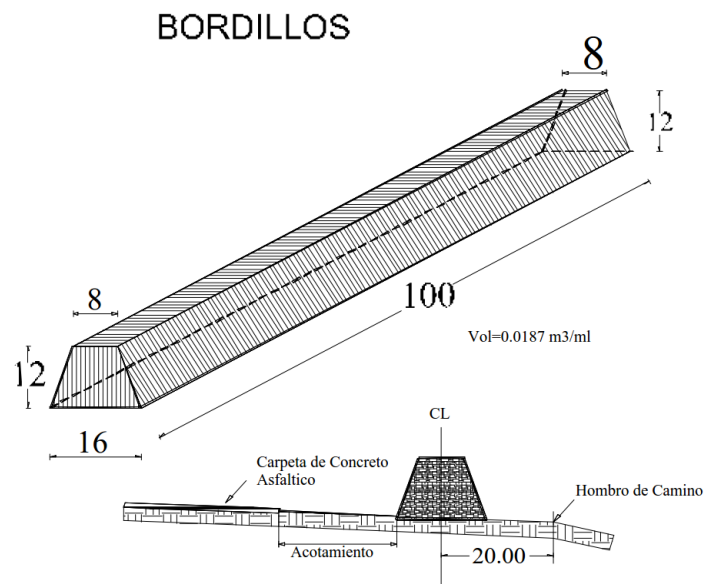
Detalle de los bordillos a construirse, en el proyecto.
